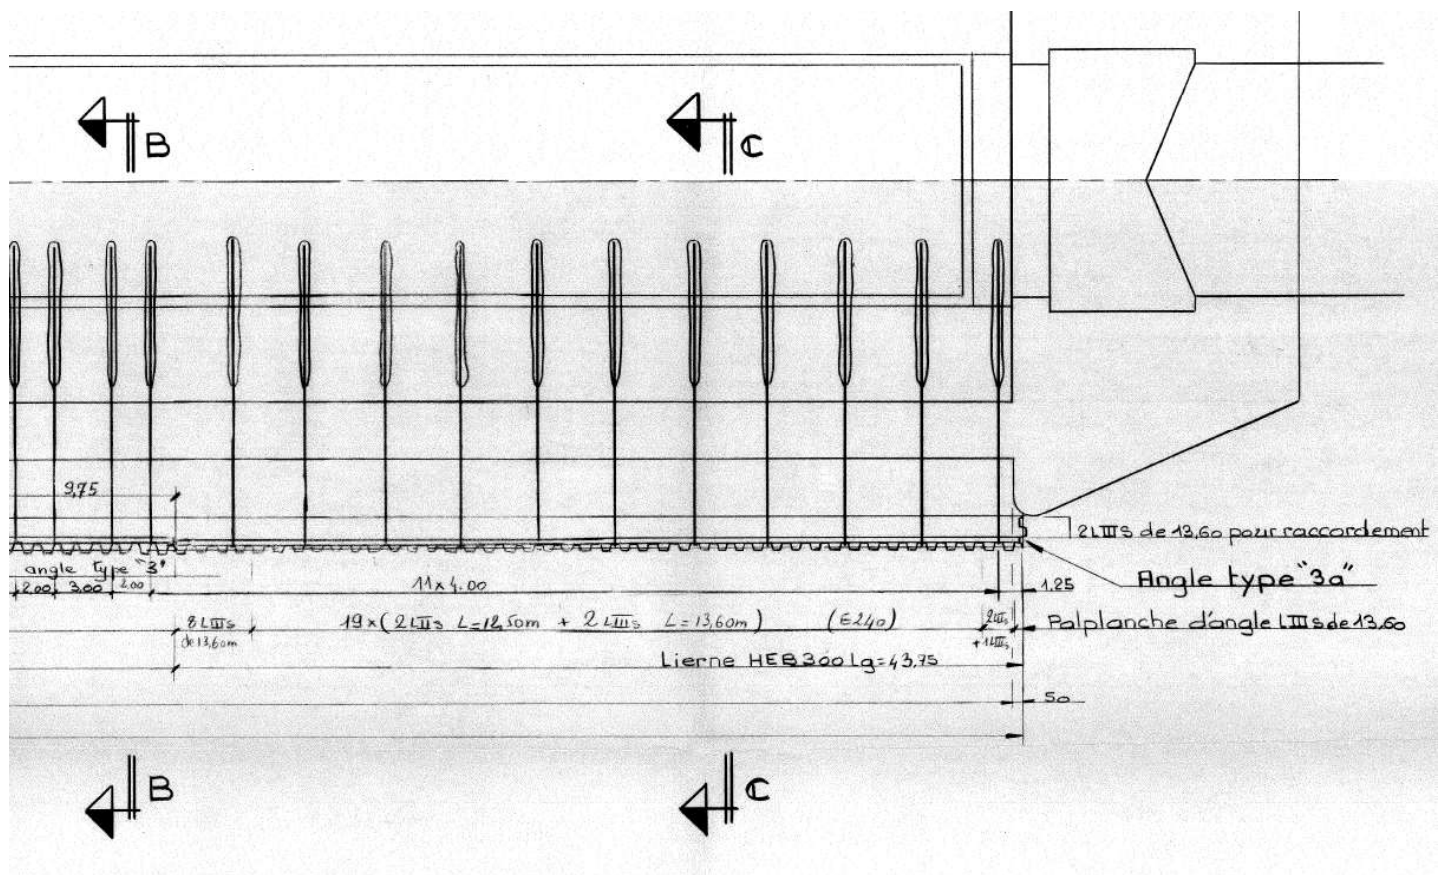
Plan rideau tirant zone barrage (Archives VNF)
